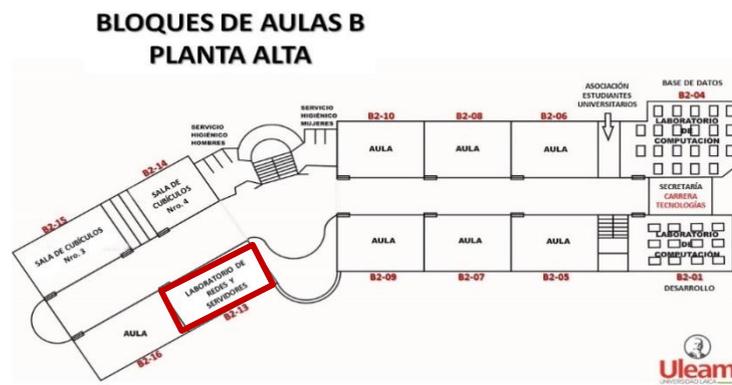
Croquis del Bloque B Planta Alta-Laboratorio de Redes
